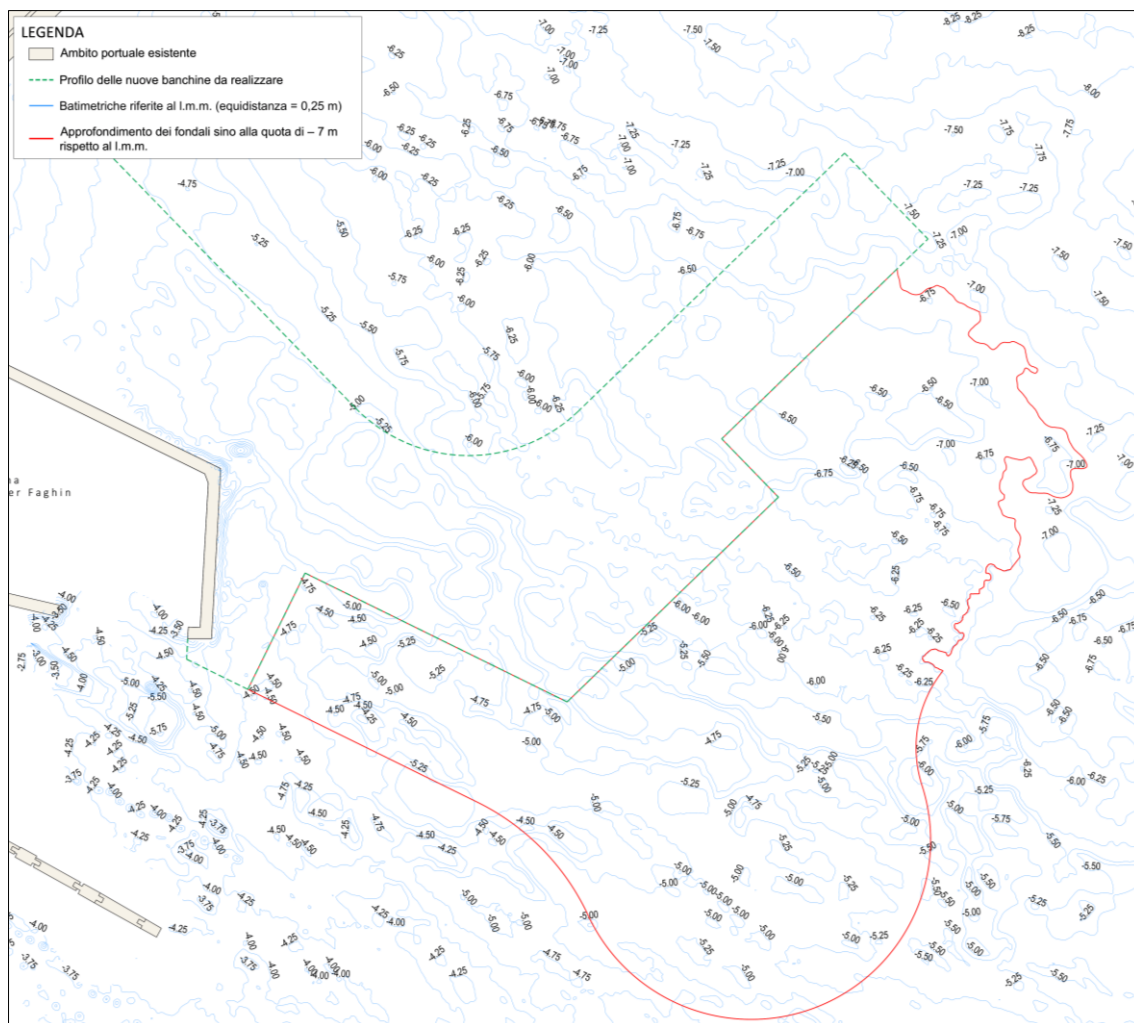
Planimetria con l'individuazione dell'area oggetto di approfondimento dei fondali
